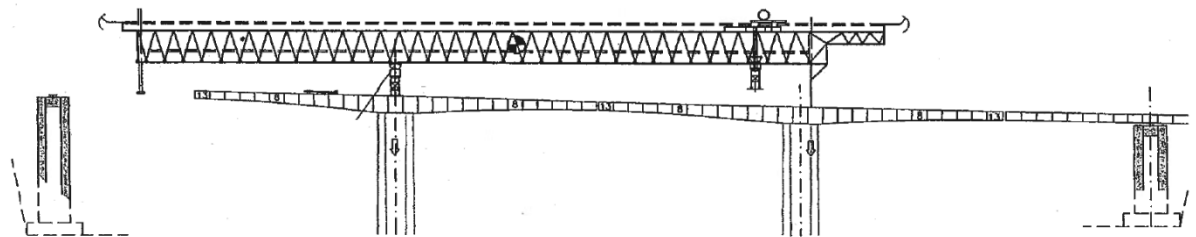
Acção da lançaadeira após betonagem da junta de fecho (fase de avanço).
